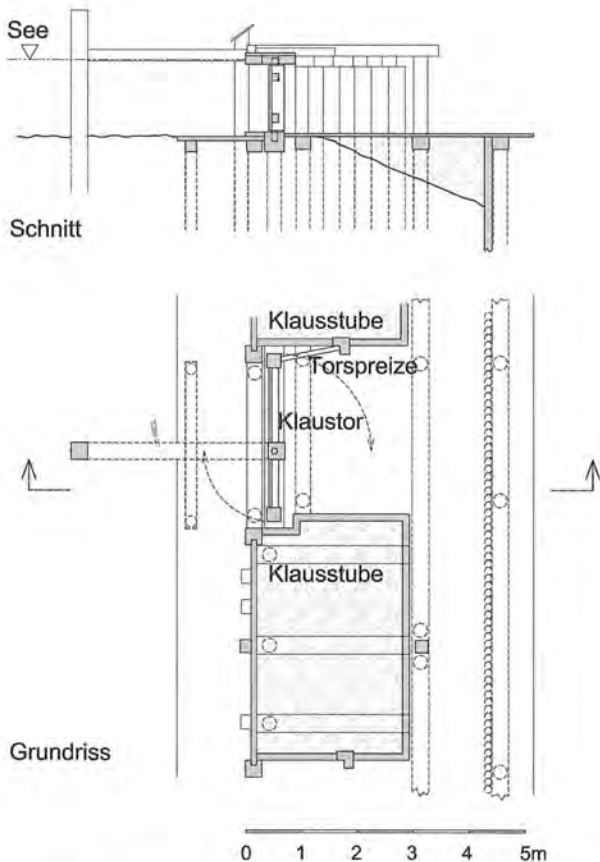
Grundriss und Schnitt eines Klaustores, Planzeichnung des Autors nach [3].
